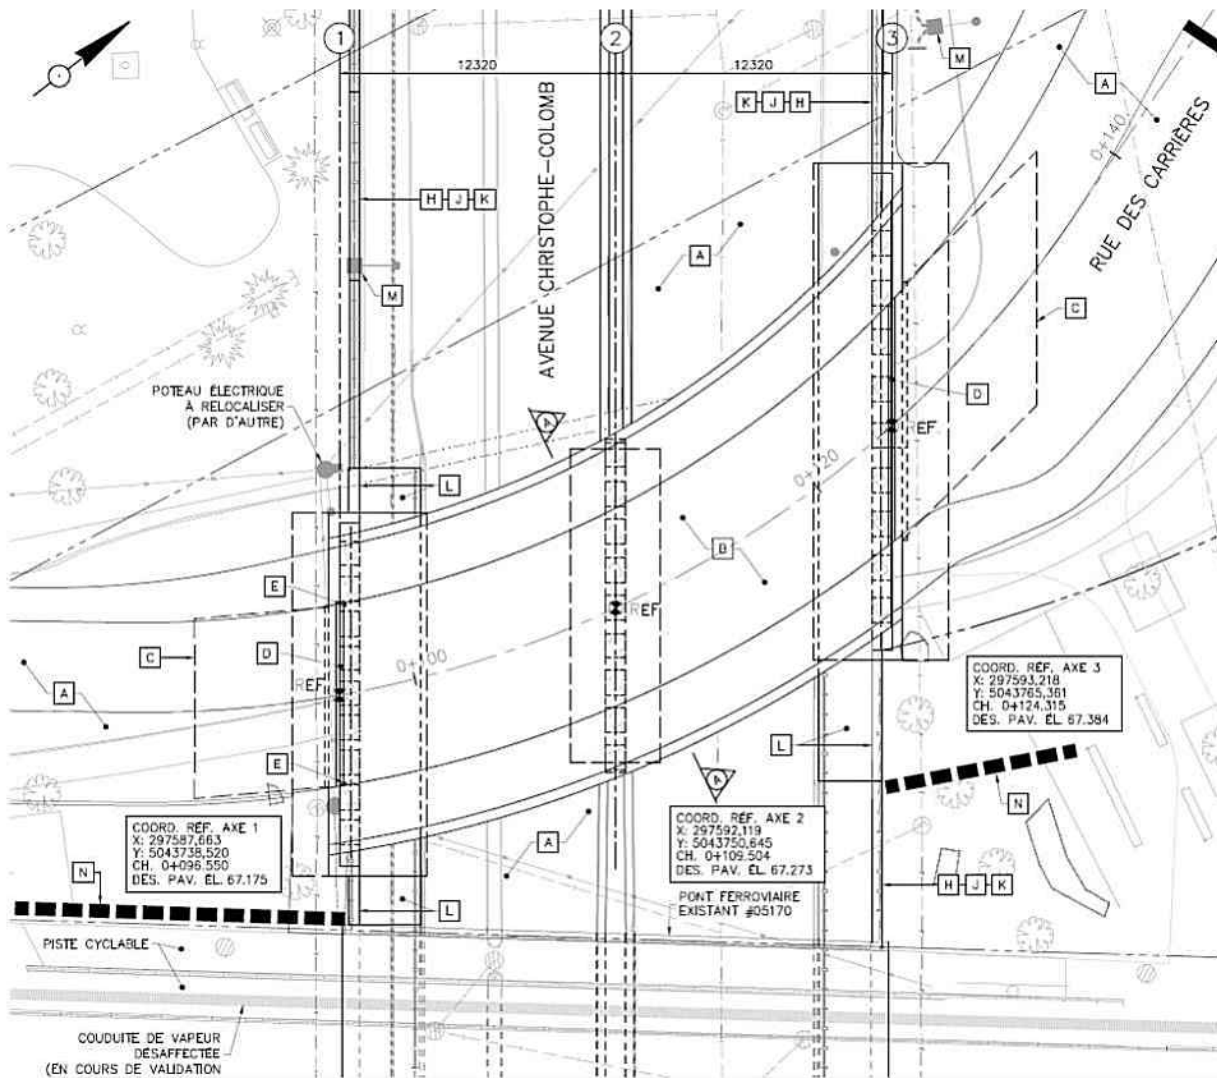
Extrait du plan d'ensemble du scénario 2 – Option dalle épaisse en béton précontraint – Vue en plan
